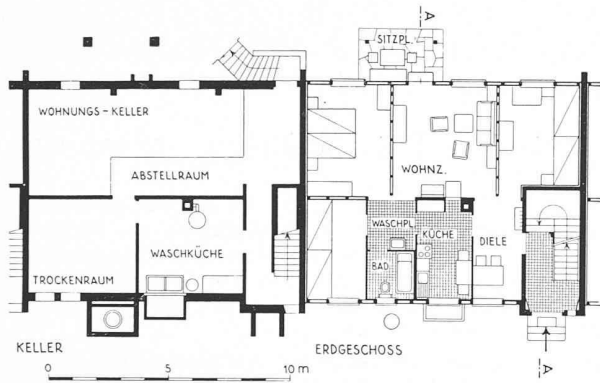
Grundrisse und Schnitt der Zweifamilienhäuser im «Schachen»; Masstab 1:300
